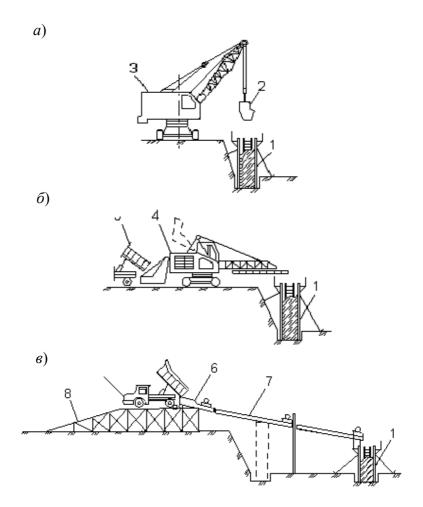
Схемы подачи бетонной смеси в опалубку фундамента: a — при помощи бадьи, перемещаемой краном; δ — ленточным бетоноукладчиком; ϵ — средствами вибротранспорта; 1 — бетонируемый фундамент; 2 — поворотная бадья; 3 — гусеничный кран; 4 — ленточный бетоноукладчик; 5 — автосамосвал; 6 — вибропитатель; 7 — вибролоток; 8 — передвижная эстакада
